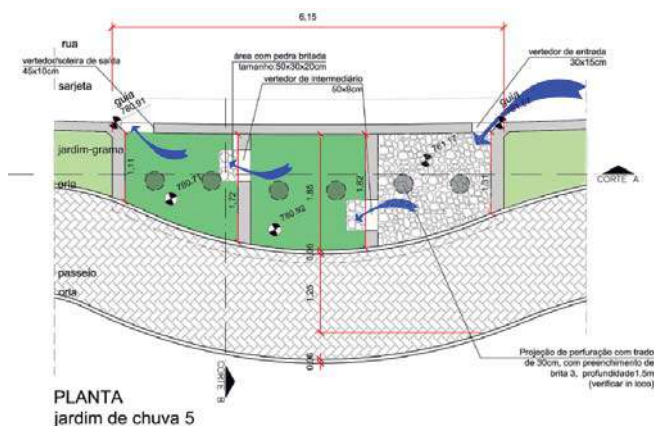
Planta de jardim de chuva. (PMSP/DEPAVE, 2012).
